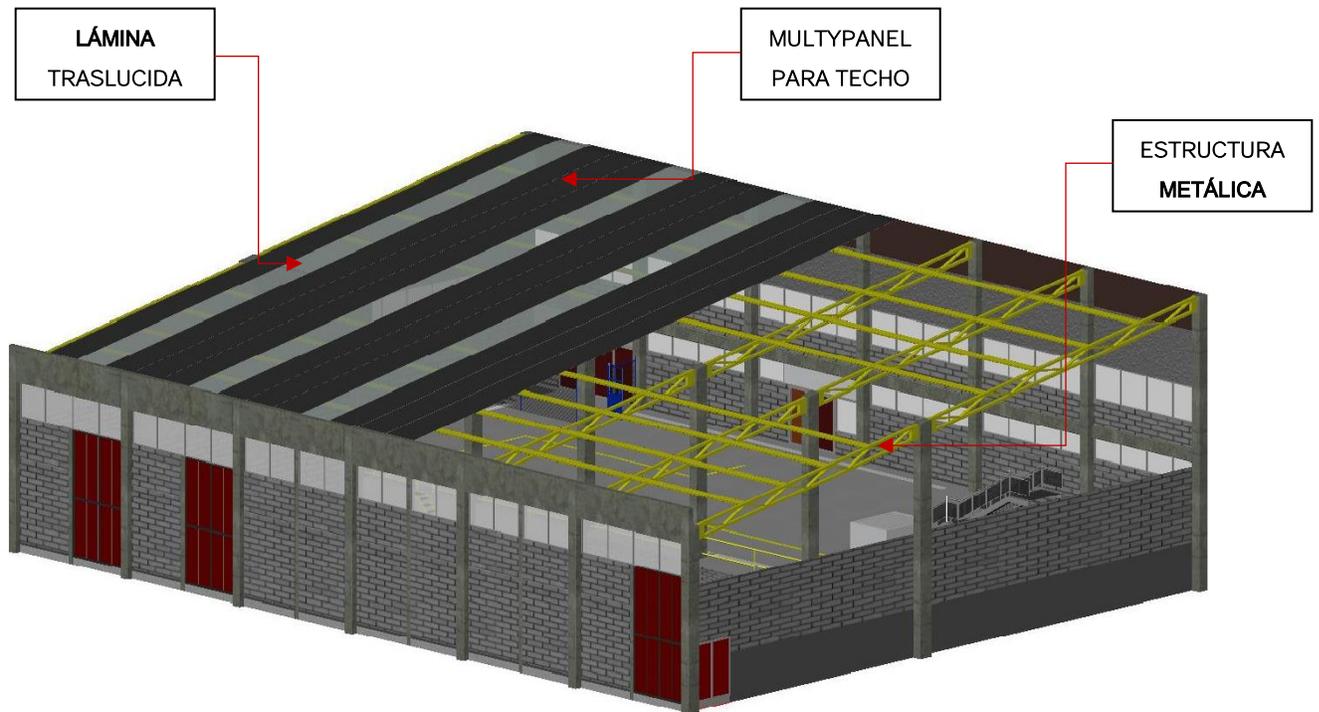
Modelo 3D- Elementos de la Techumbre en Planta Piloto.
